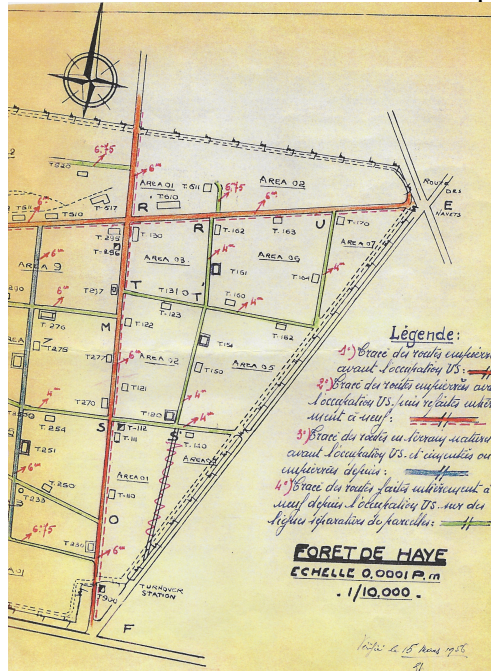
le réseau des routes tracées dans la forêt au bénéfice du dépôt de Haye dans sa partie est. Plan de 1956. Collection P. Labrude.
